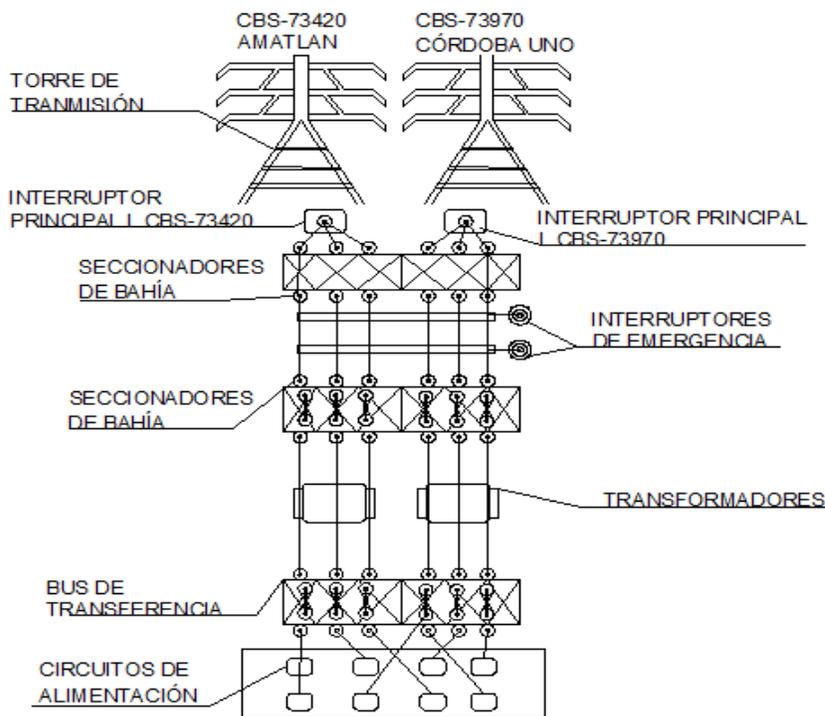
Plano de Subestación Eléctrica Córdoba Dos.
